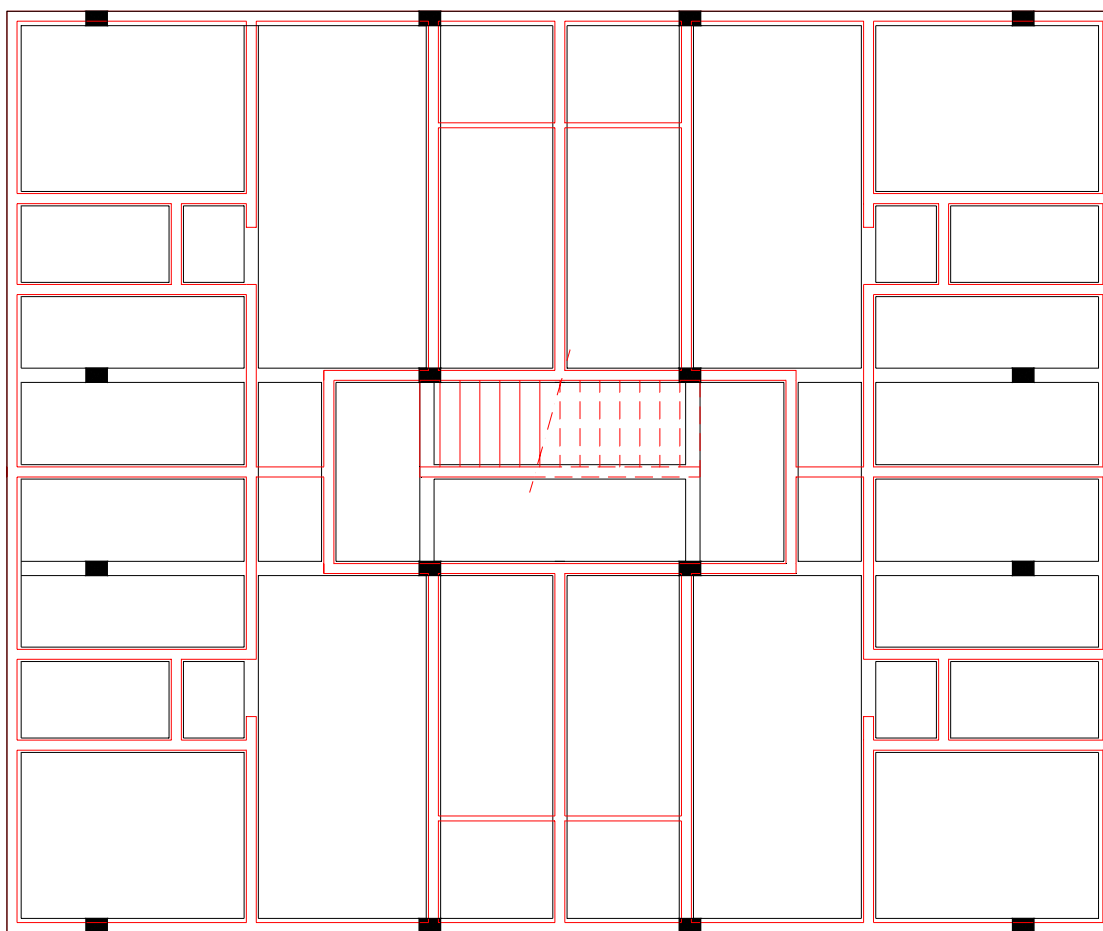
Prédio “M”– Opção 1 – Superposição das alvenarias do pavimento tipo sobre a estrutura
